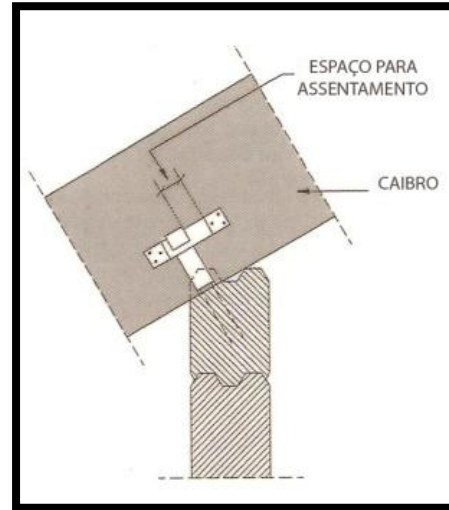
Fixação dos caibros à fachada exterior [29]
